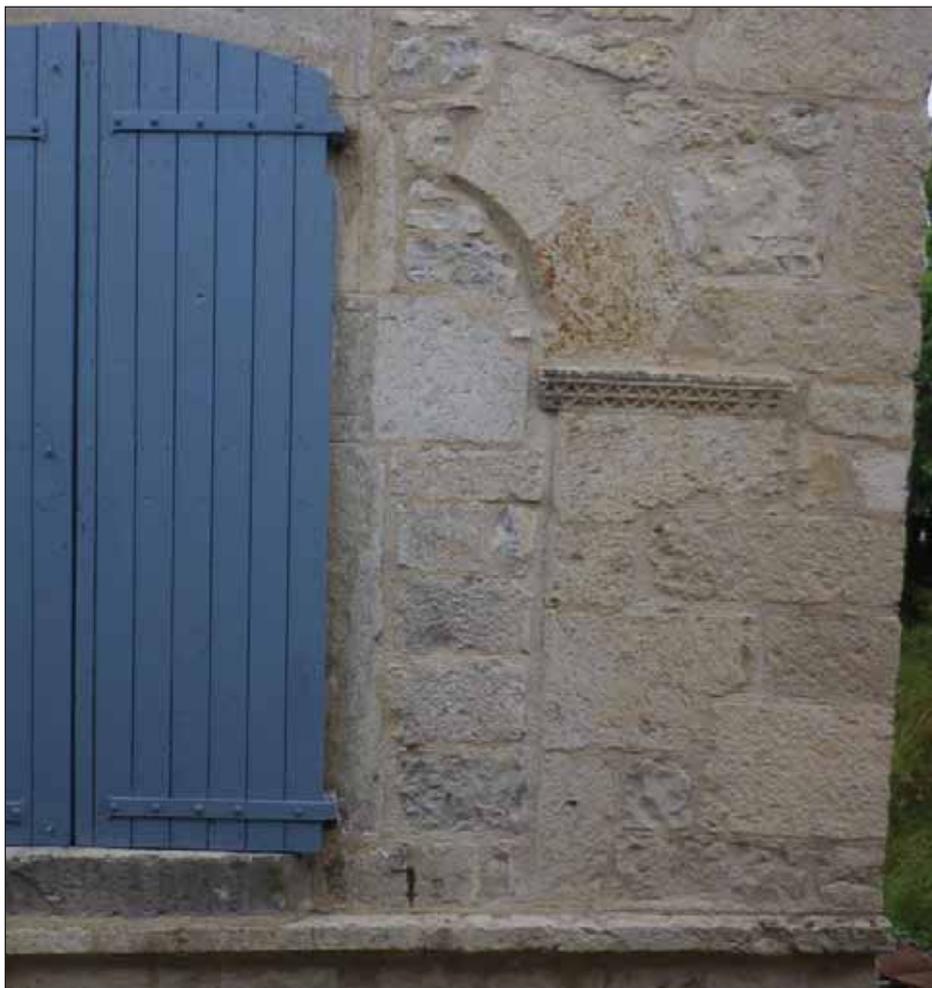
piédroit de la baie géminée de droite au premier étage sur la rue Droite
